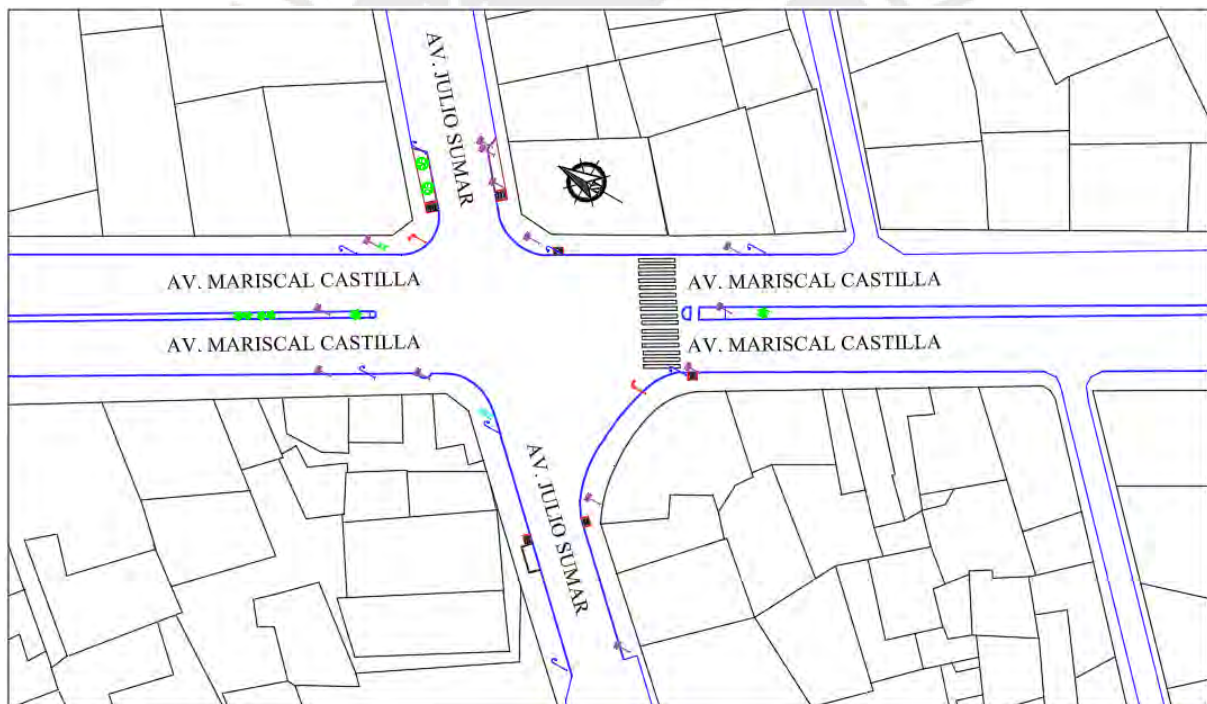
Plano de vista en planta del plano de la intersección con los elementos característicos de la infraestructura vial.
